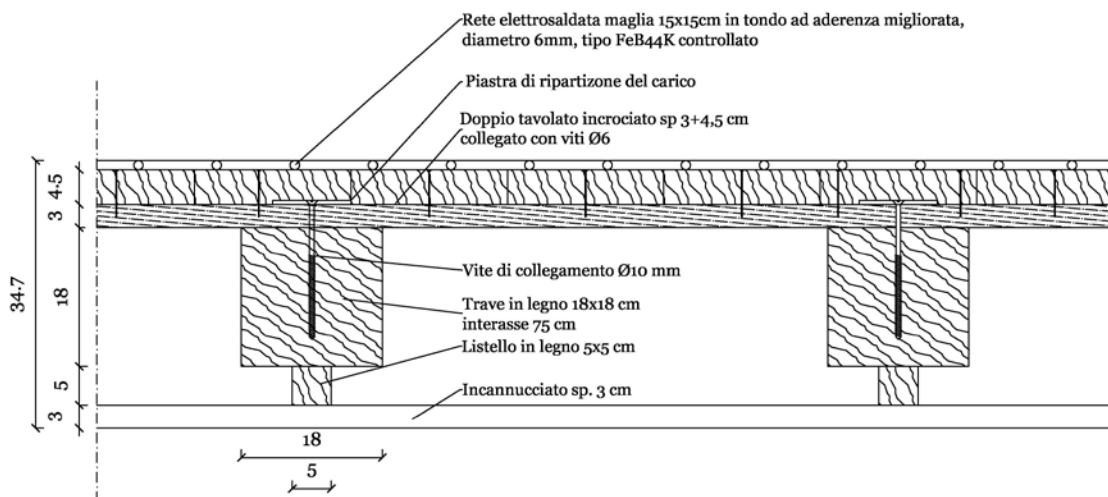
Schema solaio 03.1 – Progetto ing. Jurina
